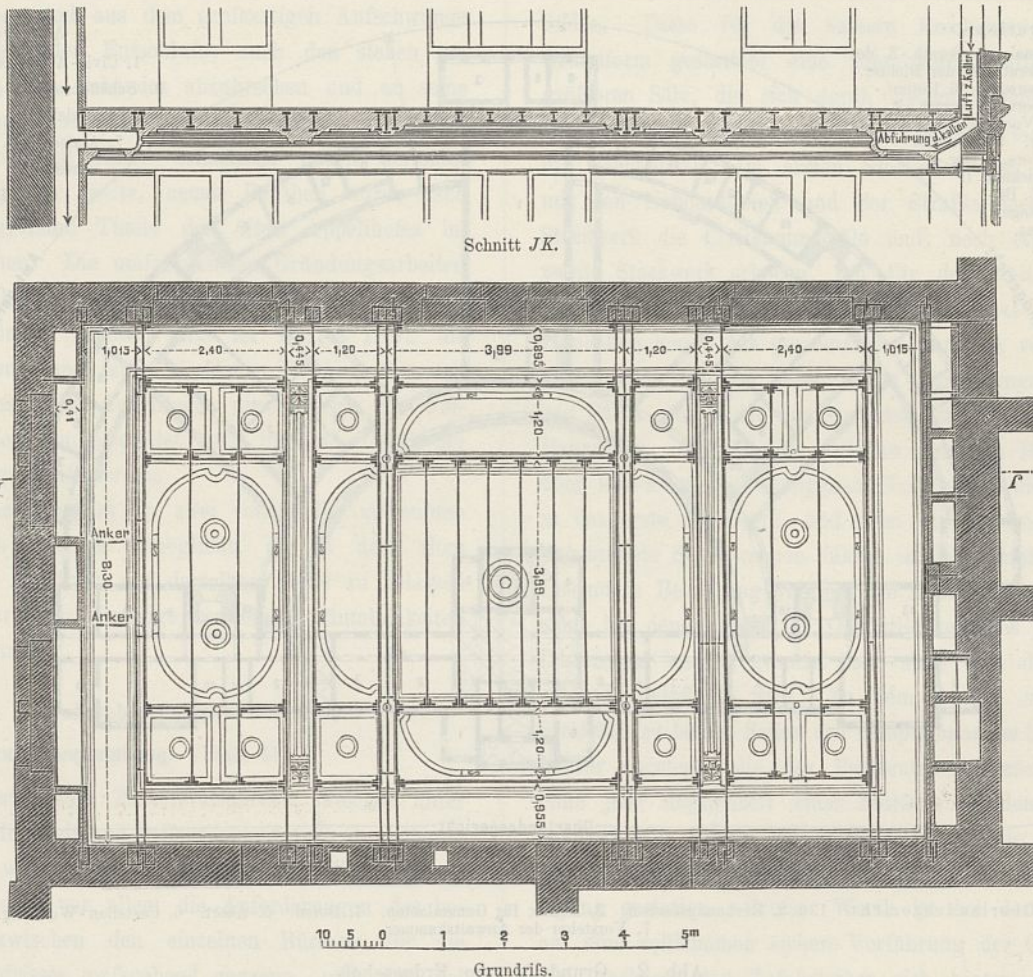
Deckenconstruction über den Schöffensälen im Erdgeschofs.
